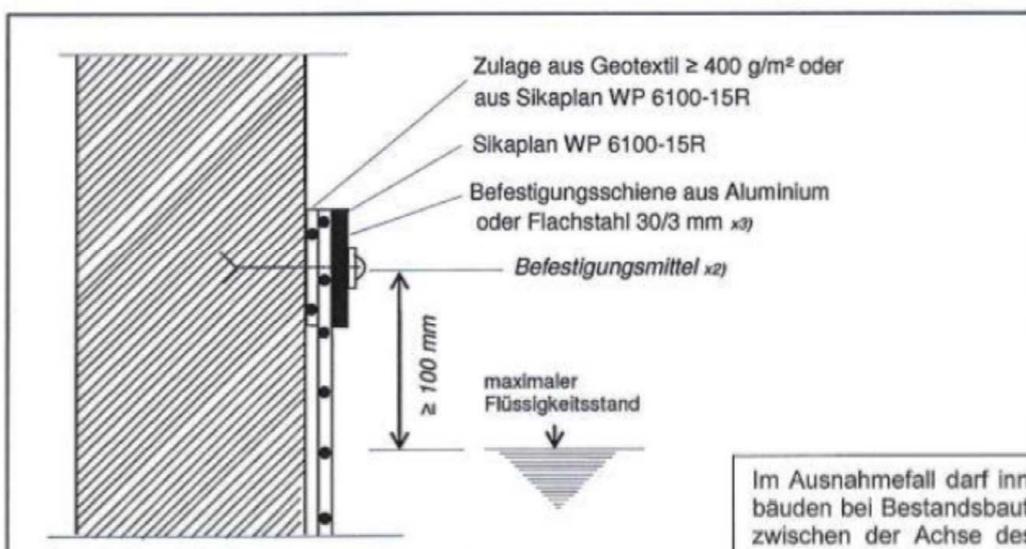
Randverwahrung mit Klemmschiene (Detail A)
